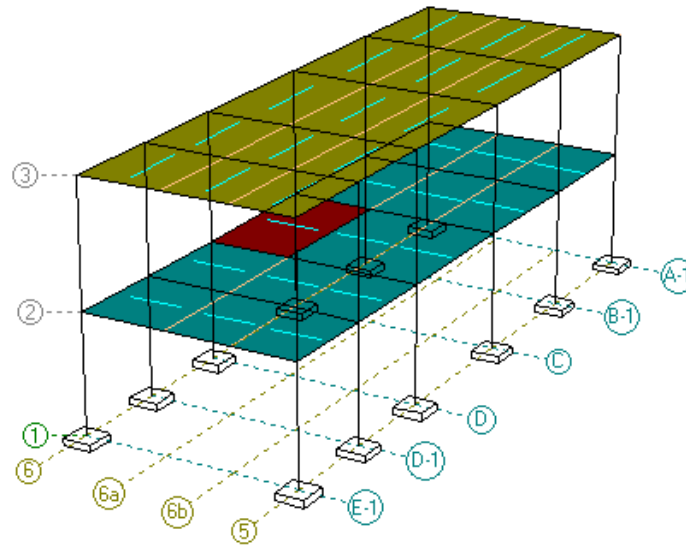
Vista 3D Modelo Estructural Edificio zona posterior entre ejes 6 y 5. Fuente: Propia
